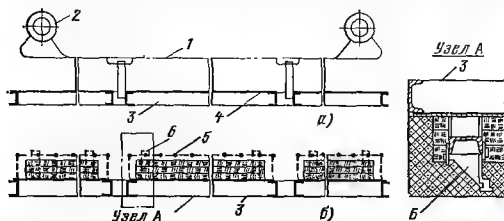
Общий вид монтажного блока НР4 котла П-50.
